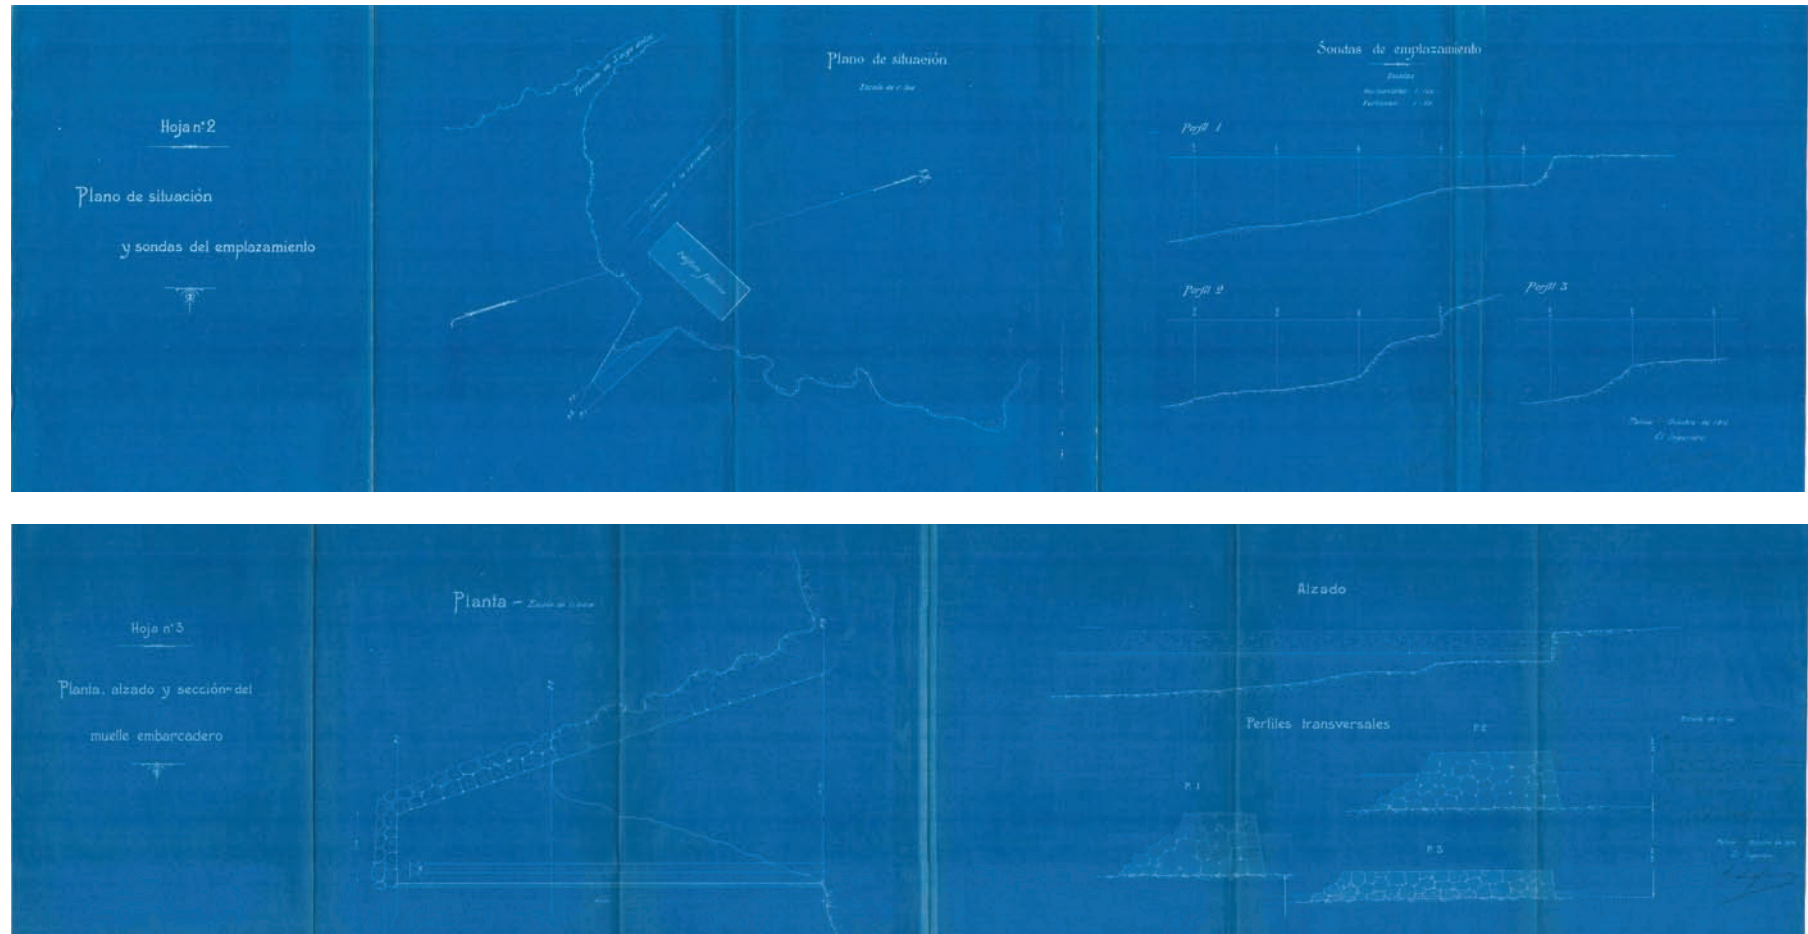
Emplazamiento, planta y detalles del Embarcadero en S'Aigo Dolça proyectado por Pedro Garau en 1910.
